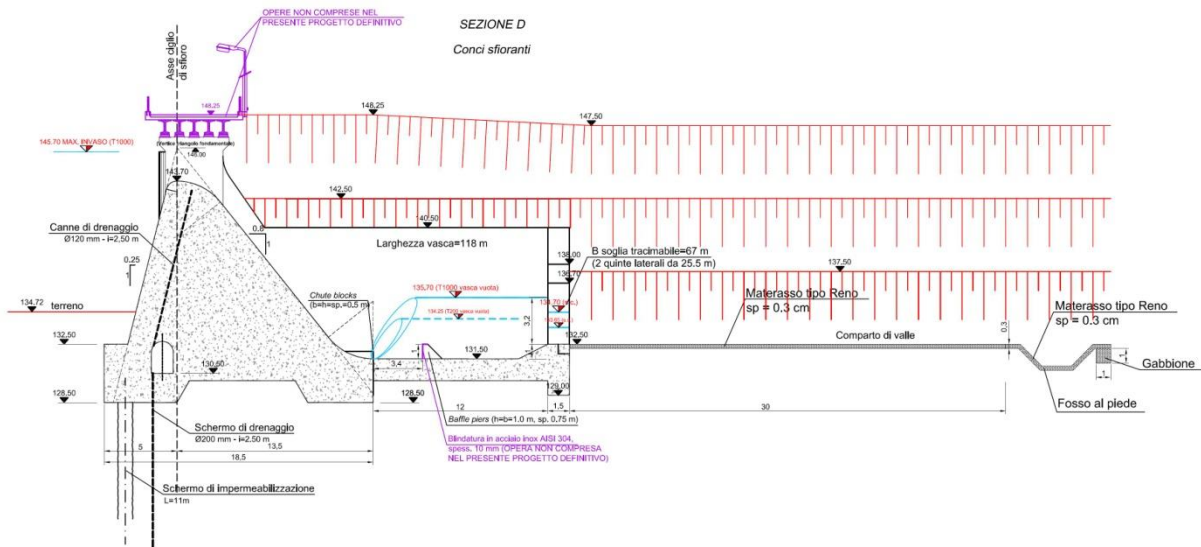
Manufatto B: sezione trasversale al manufatto.
